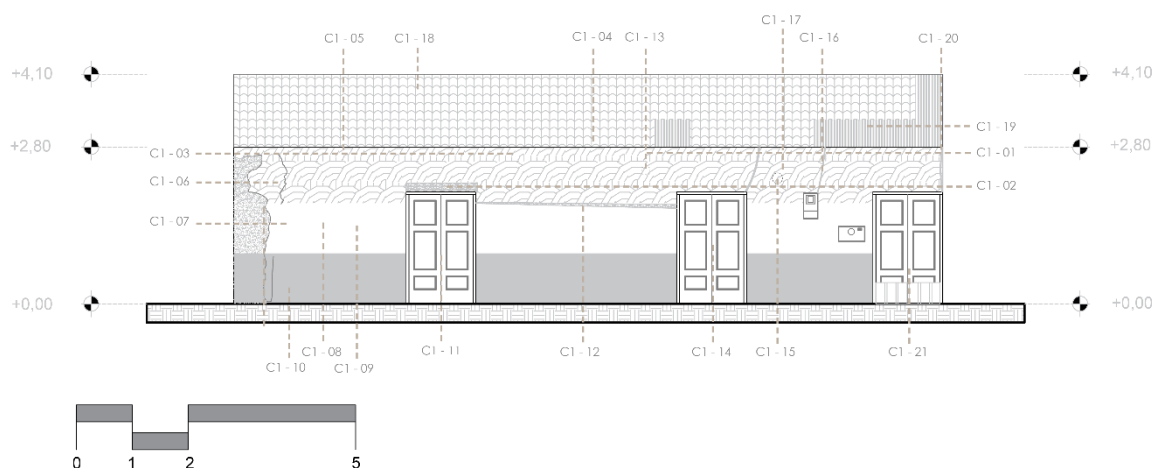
Elevación frontal con resumen de sus patologías de la primera vivienda
